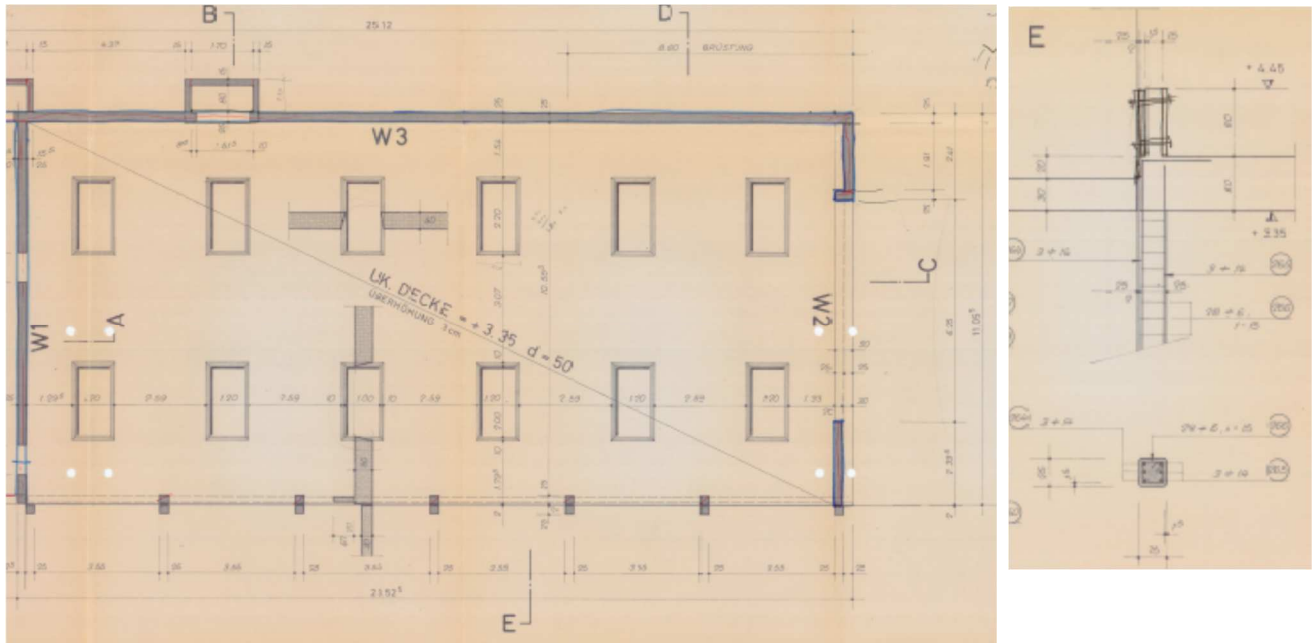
Grundriss des untersuchten Gebäudeteil 1 «Garage» (links) und Stützendetails (rechts)
